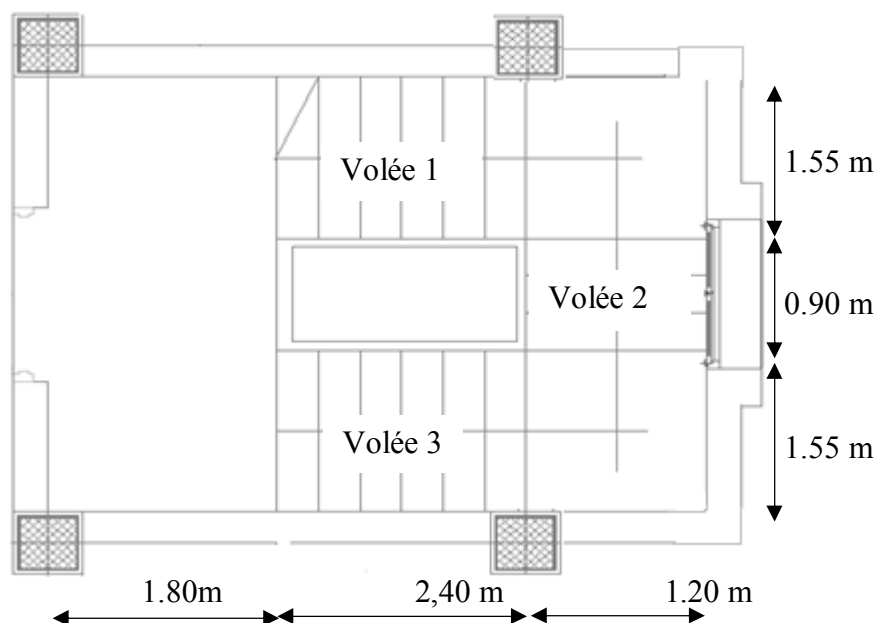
Vu en plan de l'escalier (type 2)
